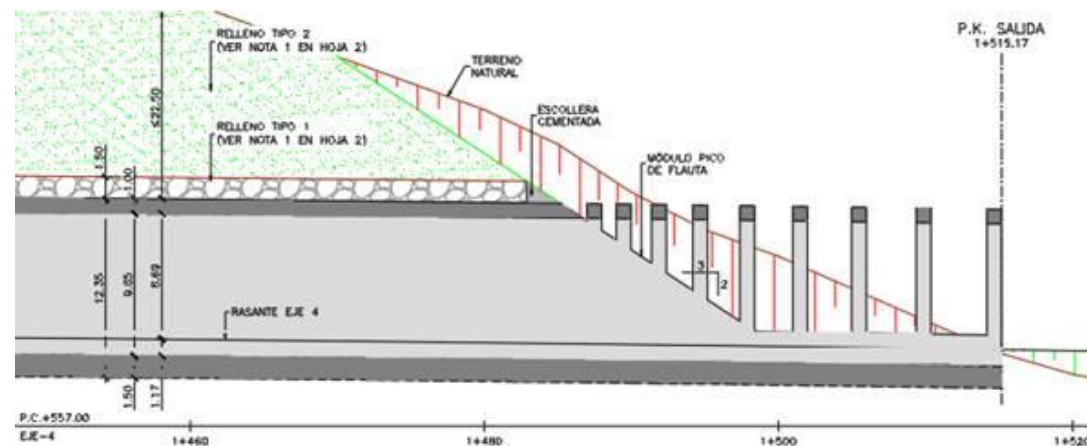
Falso túnel de salida. Perfil longitudinal
